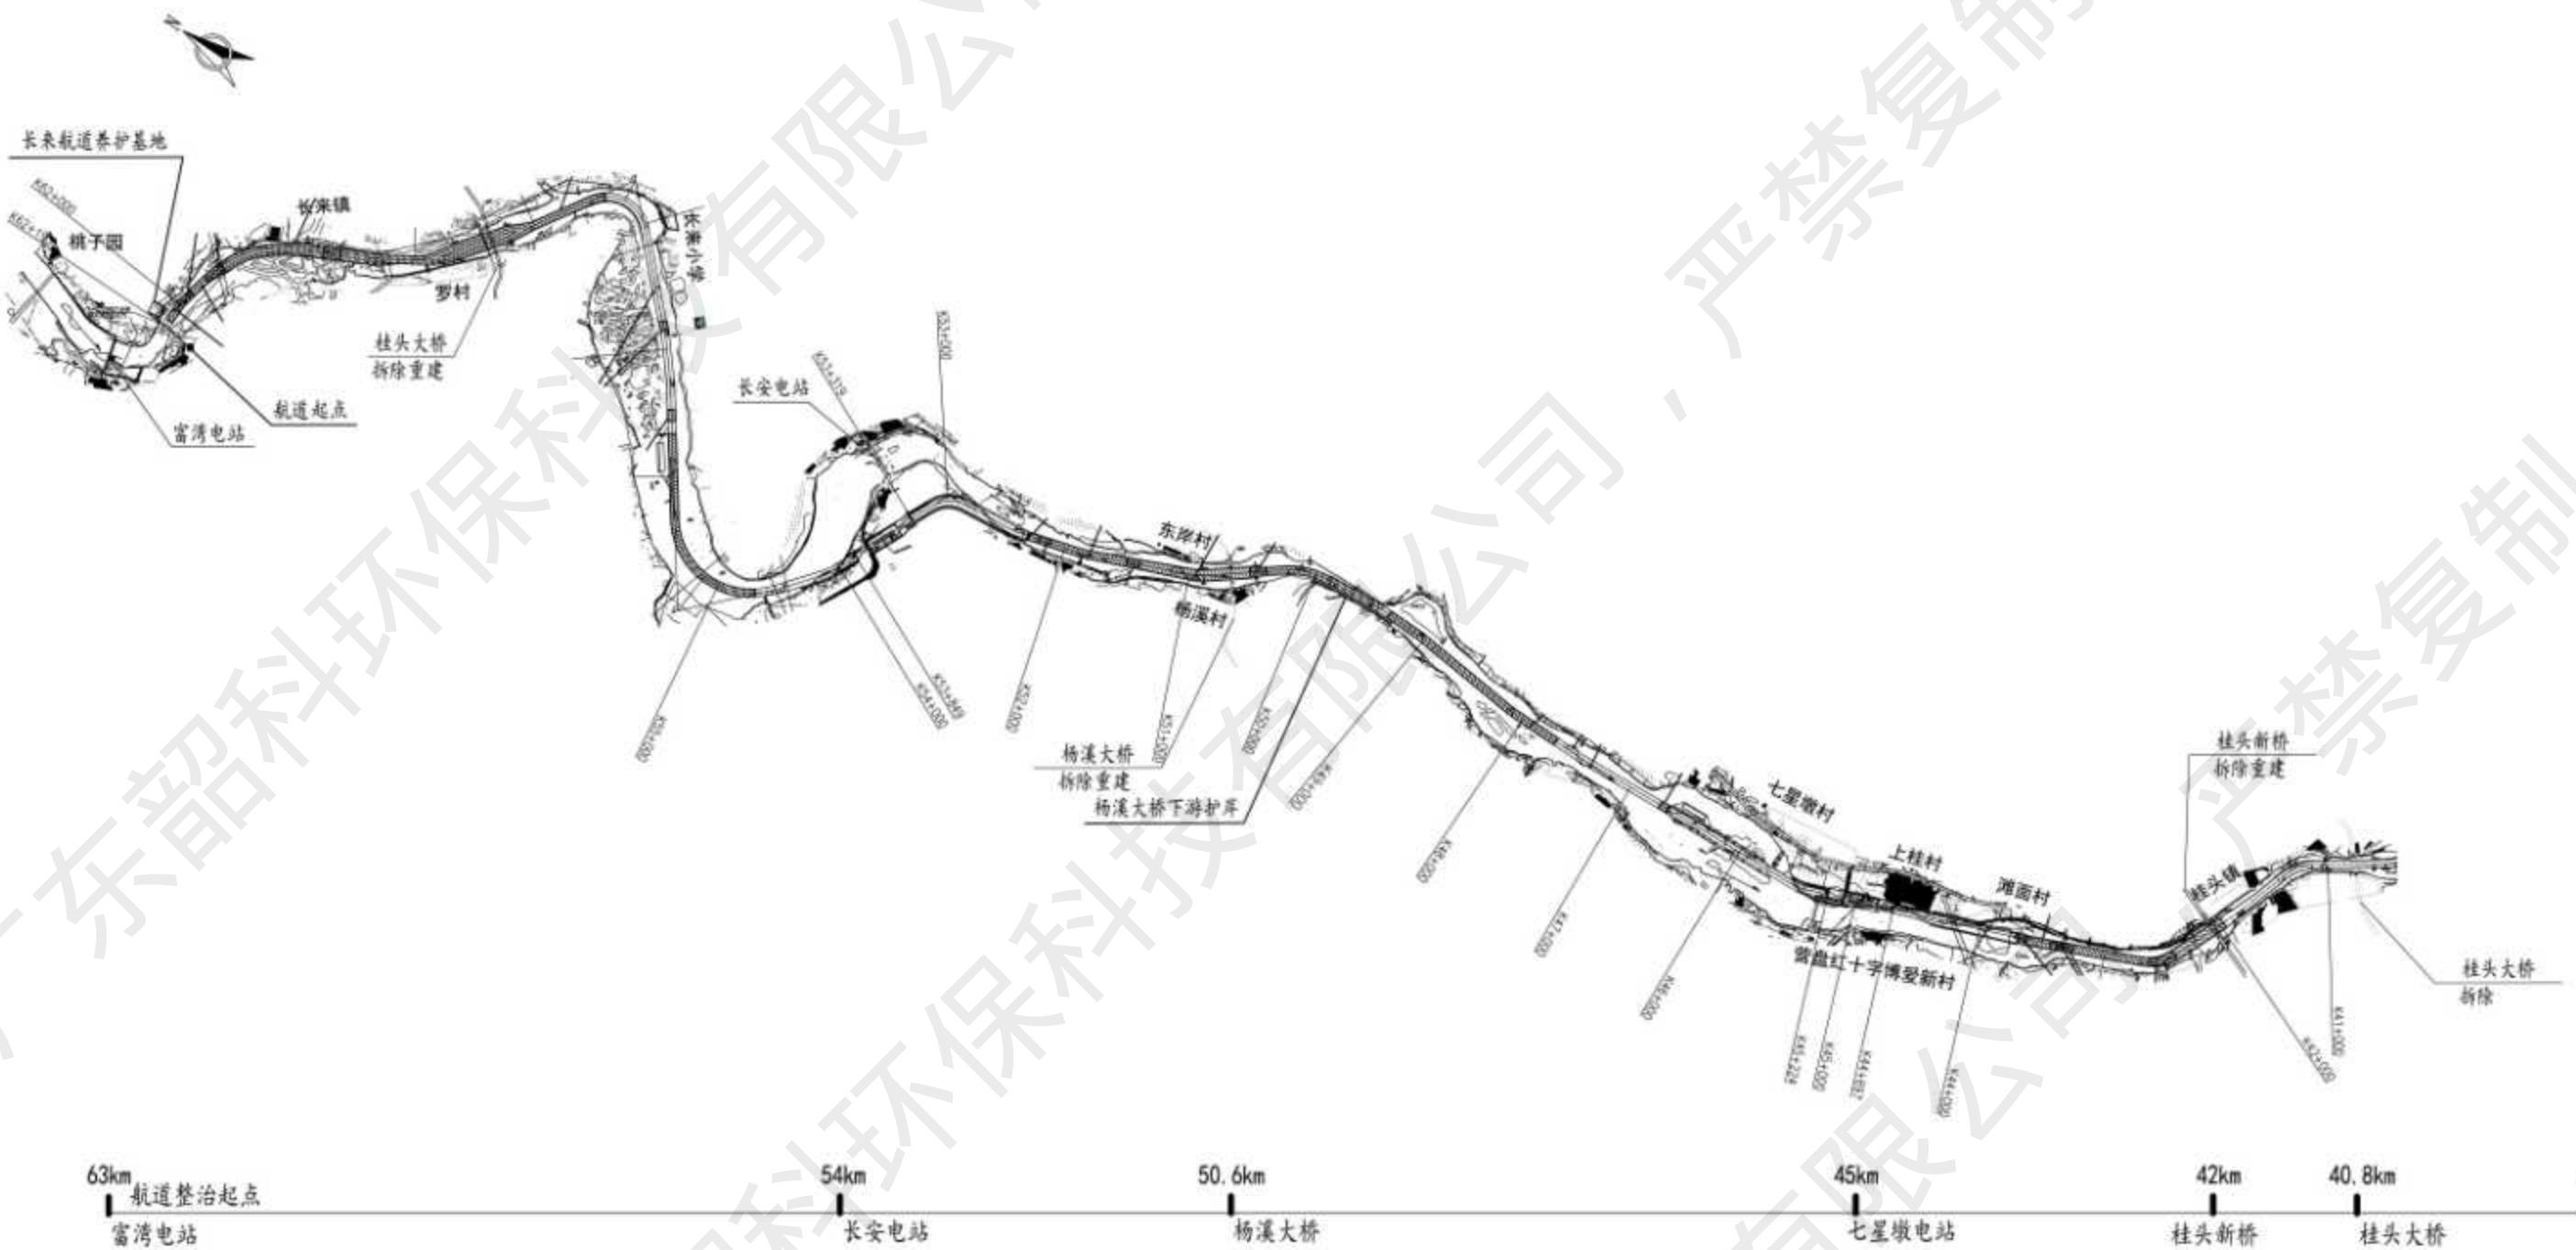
本工程（航道工程、桥梁工程、船闸工程）总平面布置图
